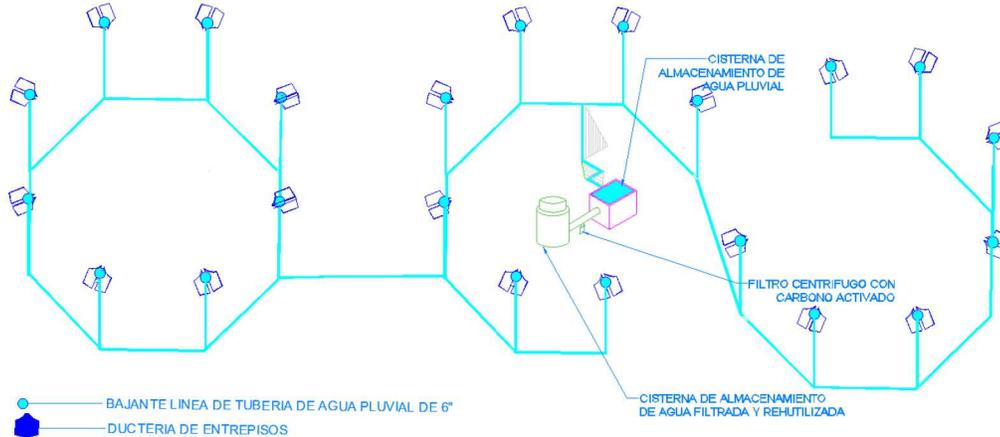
Plano de sistema de captación de agua pluvial planta (sótano)
